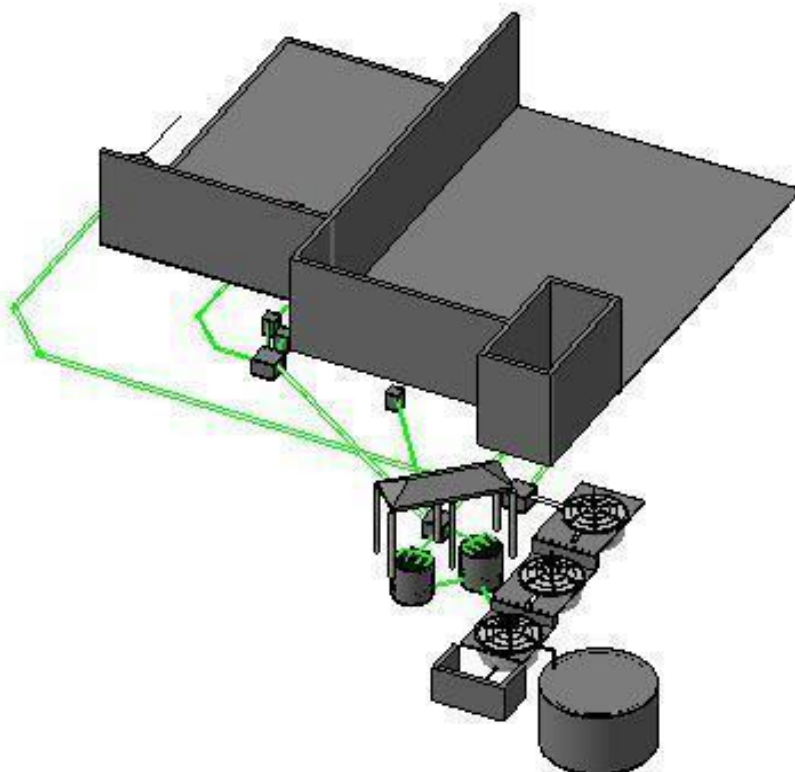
Planta 3d com instalações do sistema de tratamento de esgoto
